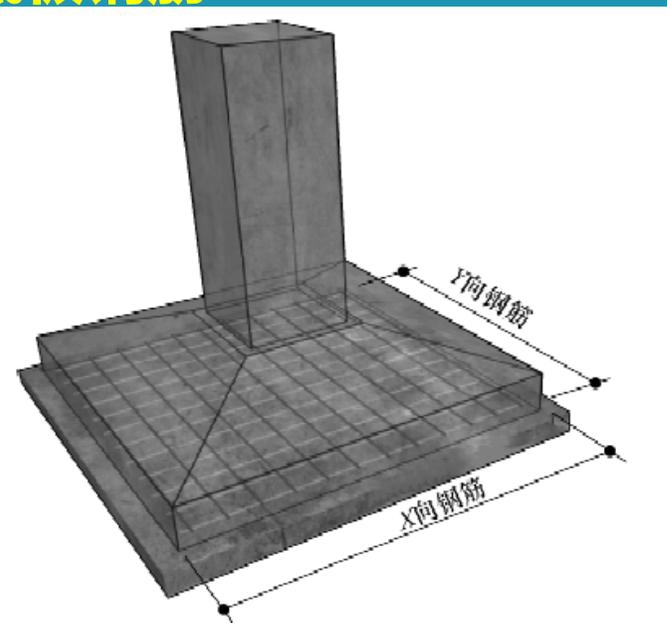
柱下钢筋混凝土独立基础底板钢筋
